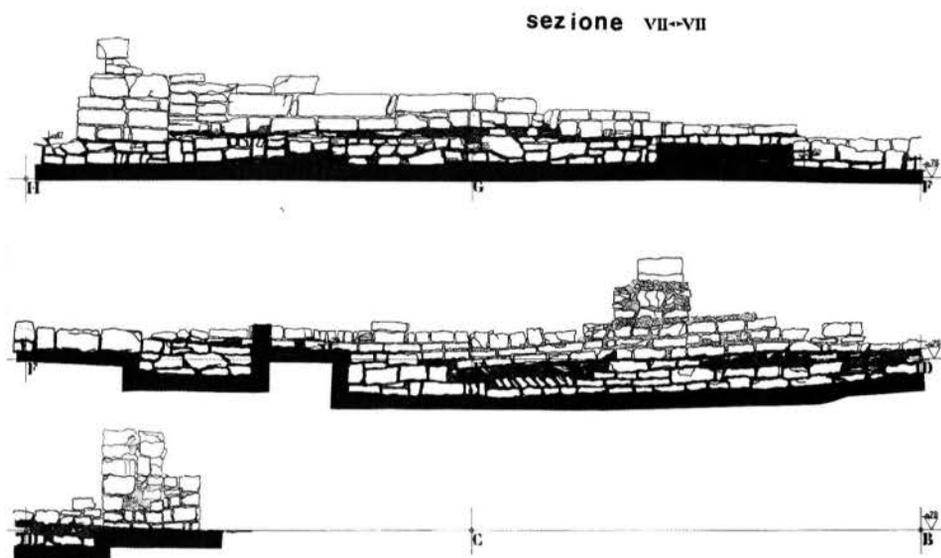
Chiesa meridionale, sezione VII-VII.
